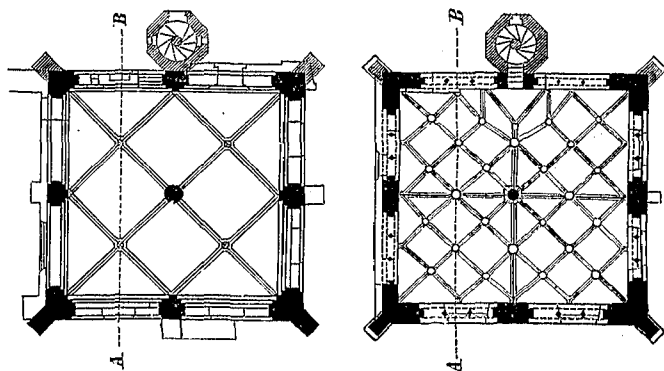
Grundrisse. (Nach dem Restaurations-Entwurf No. 4.)
